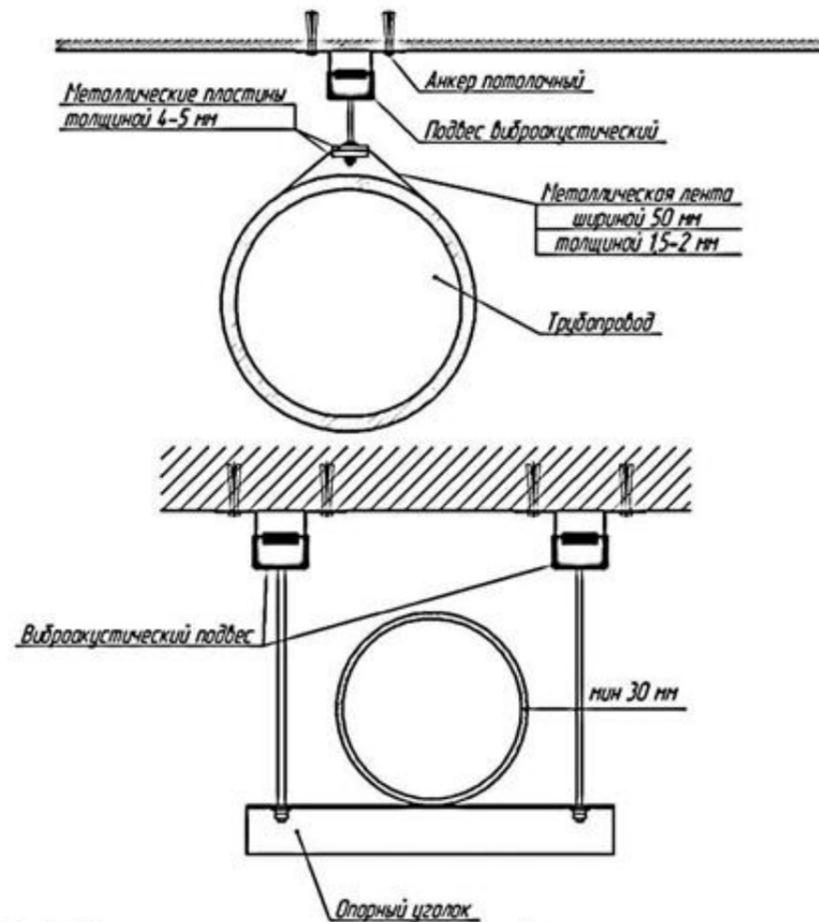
Крепление магистральных трубопроводов к перекрытиям:
